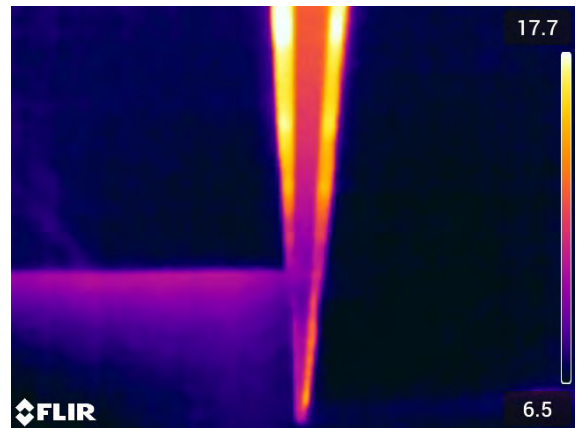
CA\_14: condizione di rilevazione passiva, fascia oraria 18-19. Prospetto ovest.
